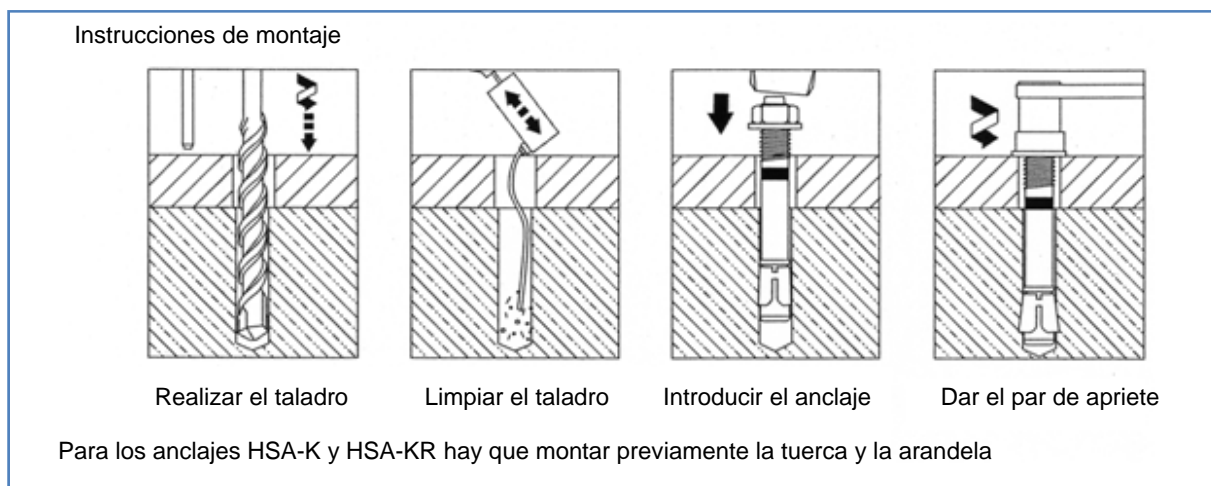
Instrucciones instalación Pernos de Anclaje
